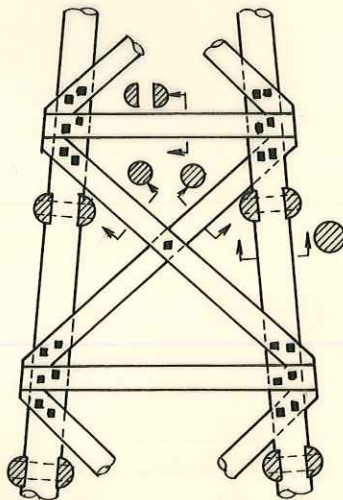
SEÇÕES DE BARRAS COMPOSTA DE "MEIA-TORA"
